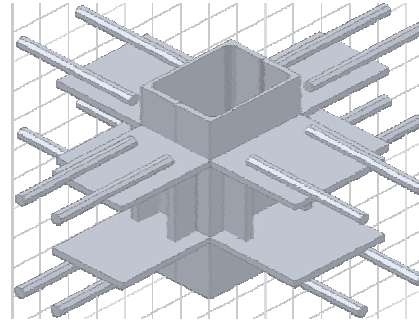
Металеві конструкції вузла з'єднання сталезалізобетонних колон зі швелерів із монолітною залізобетонною безбалковою плитою
